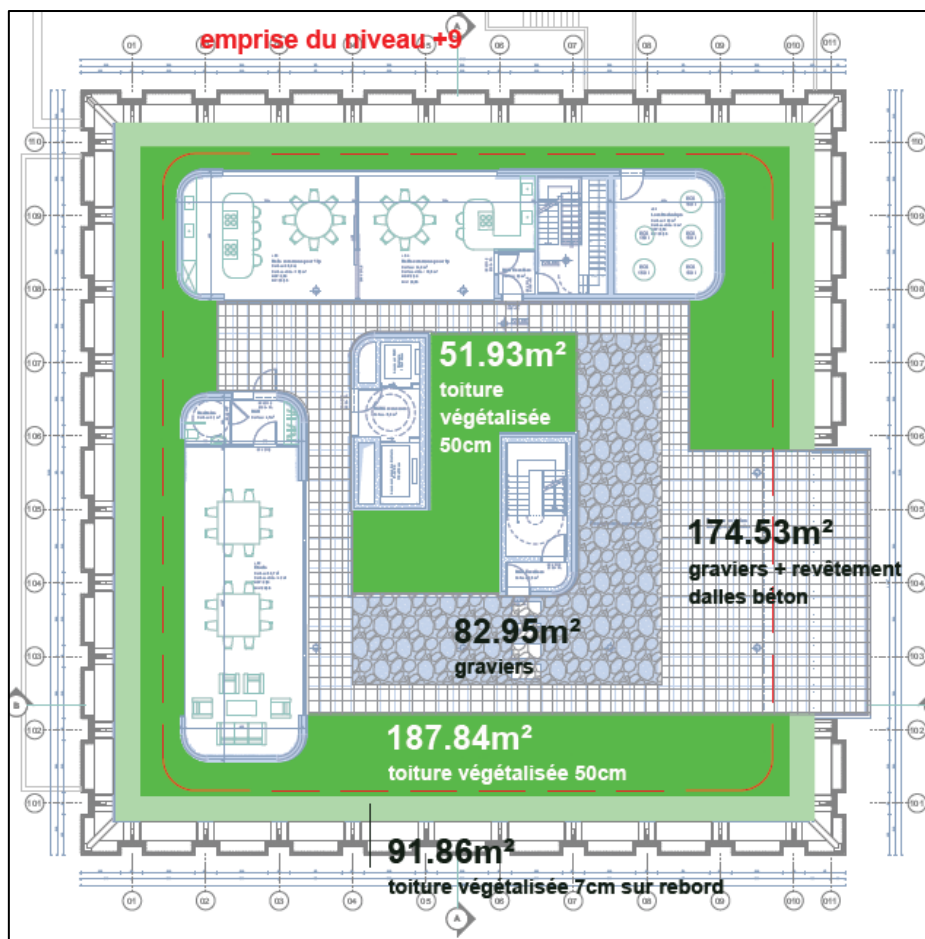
Toiture du niveau +8 (Source : POLO et Baumans Deffet)
